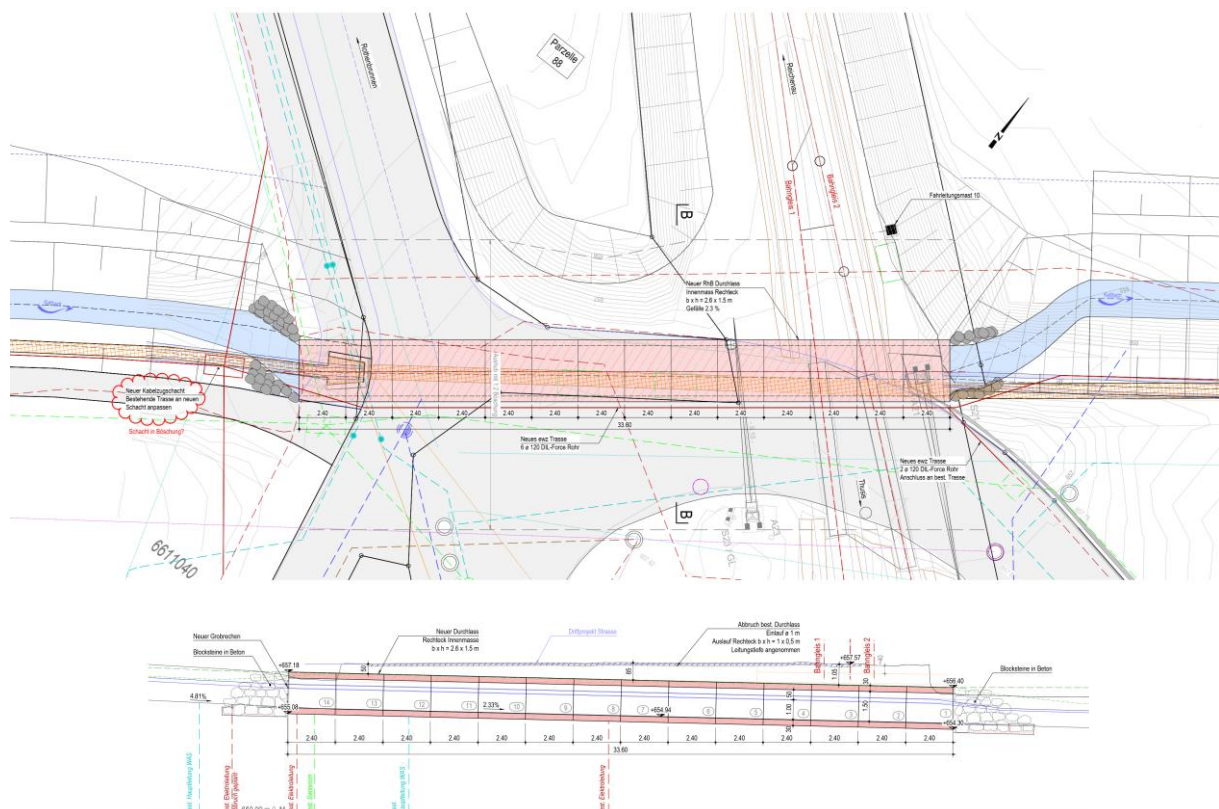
Variante 1 → Ist Lage, Grundriss und Längsschnitt
